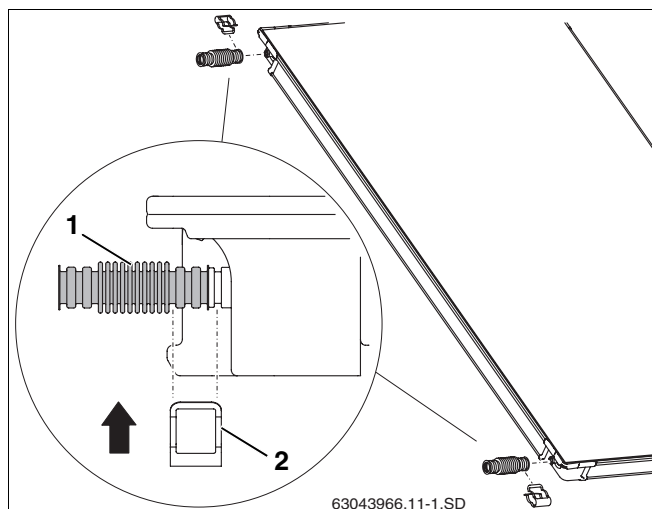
Montaje de la unión de tubo ondulado al primer colector
